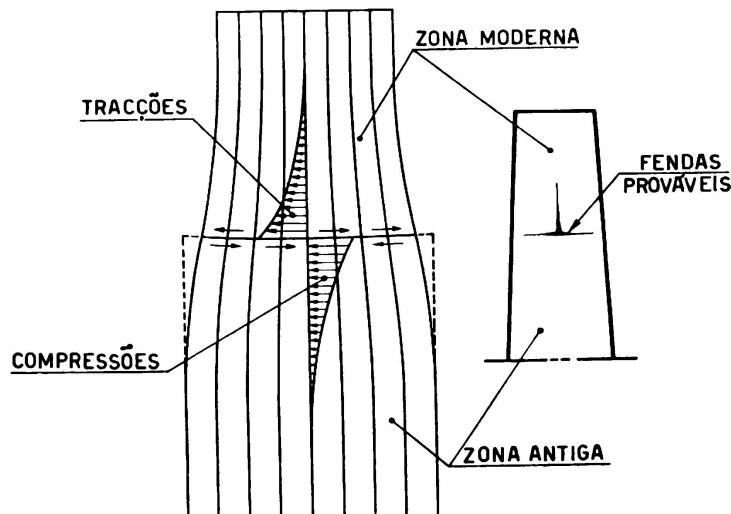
Tensões devidas à contracção diferencial num pilar. Fendas prováveis
